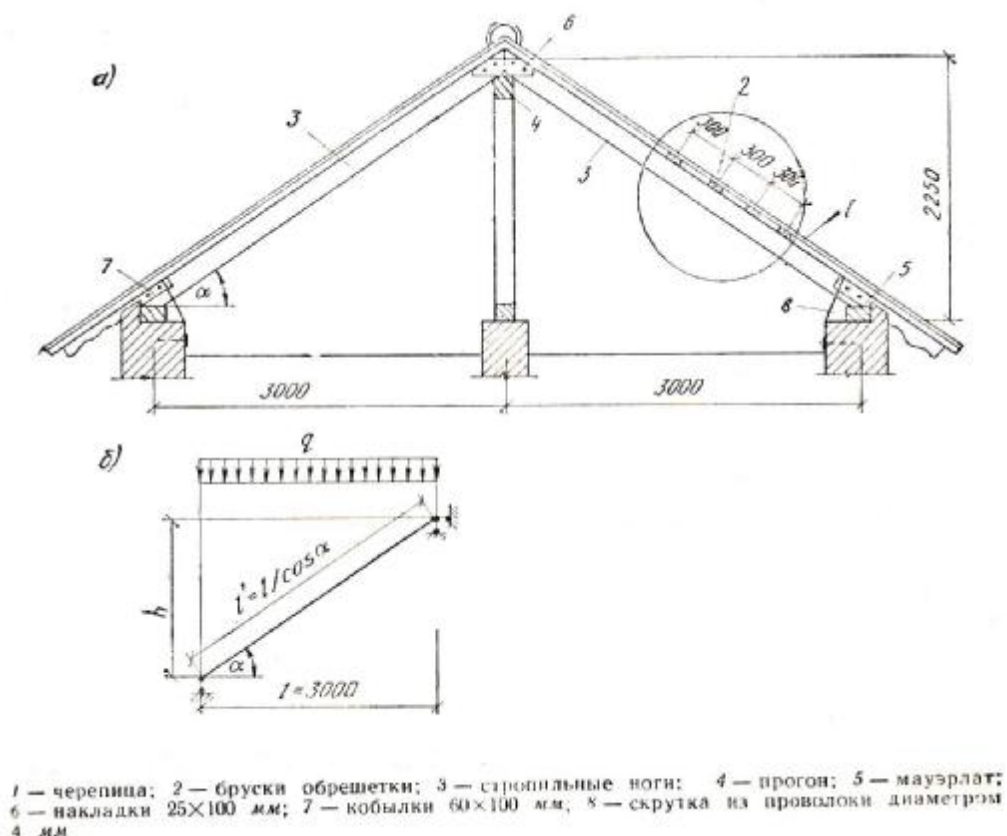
Устройство кровли (а), расчетная схема стропил.
